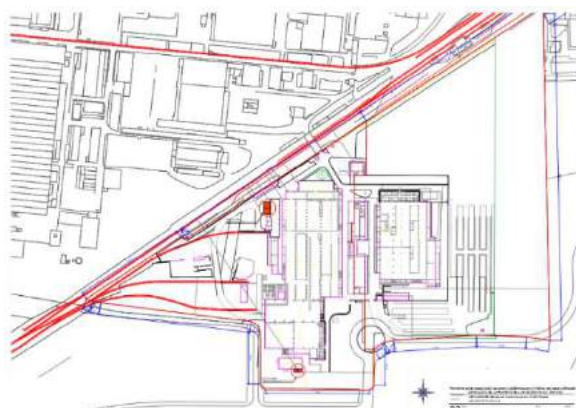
Plano General de planta. Elaboración Propia.
